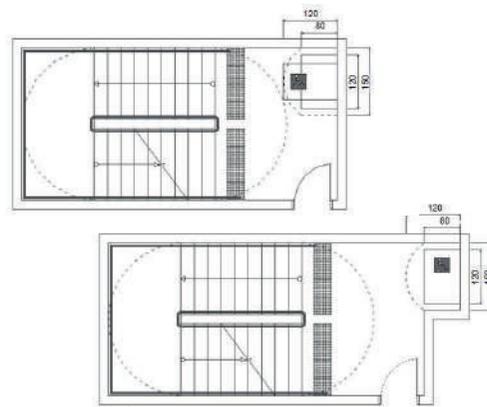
Área de resgate junto a escadas e em espaço confinado
